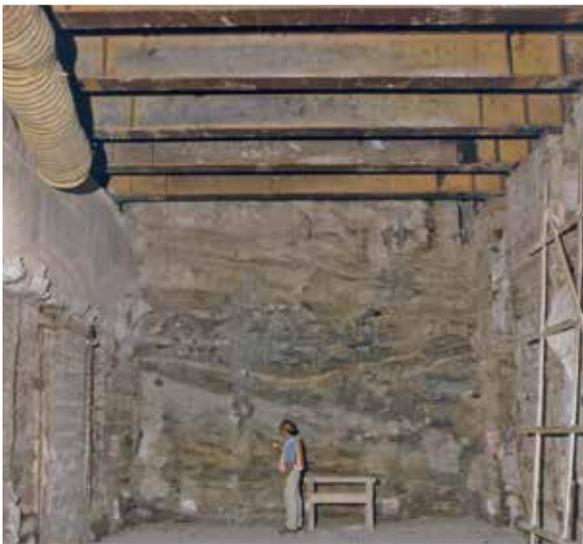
Verifiche sul Jet-Grouting nella zona interna tra i muri A e B.
